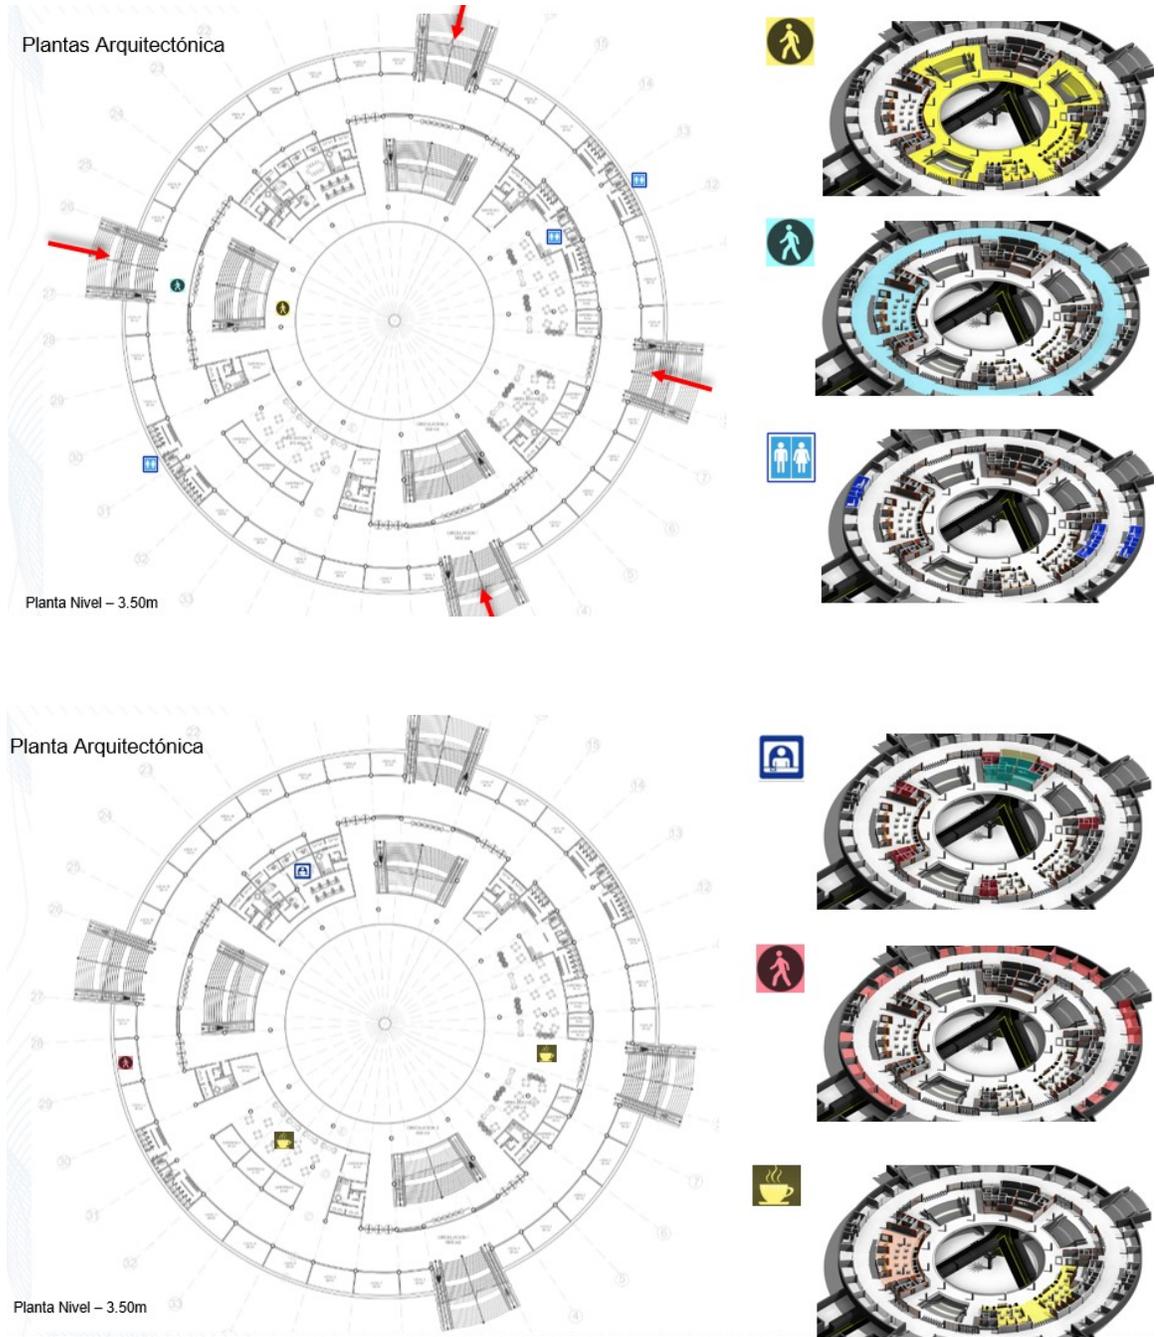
Planta Arquitectónica Nivel -3.50m
